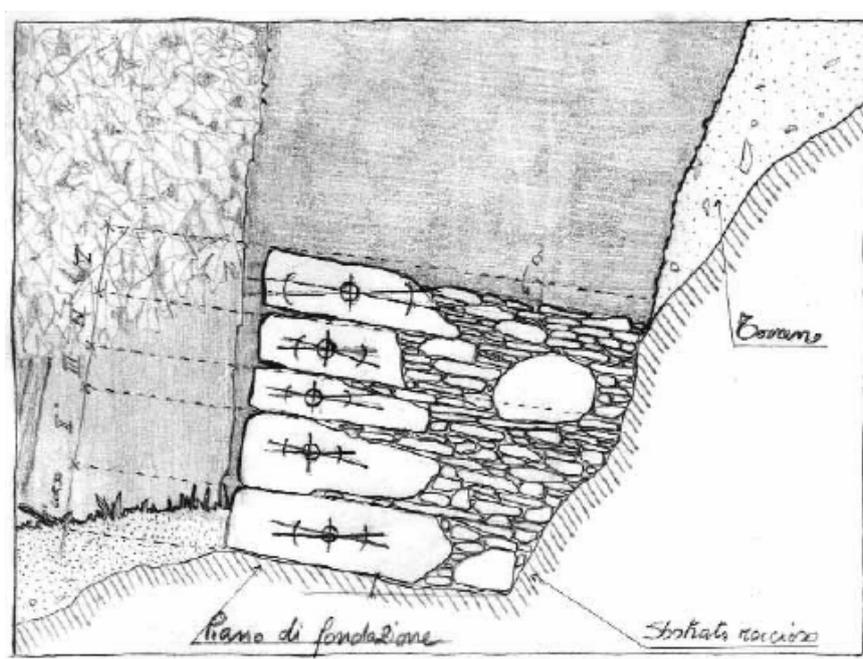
schema operativo di costruzione muretto a secco, particolare 1
